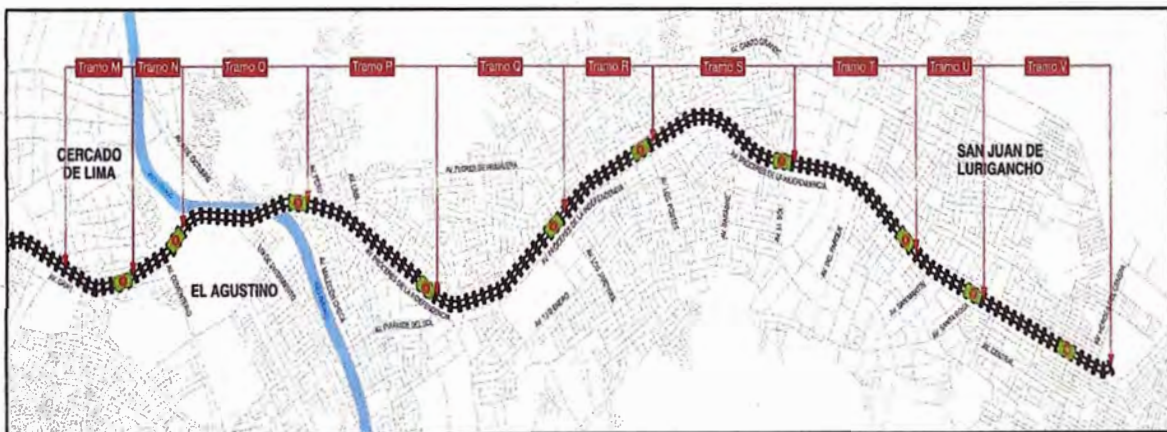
Proyección el Viaducto elevado, longitud 12.40 Km
